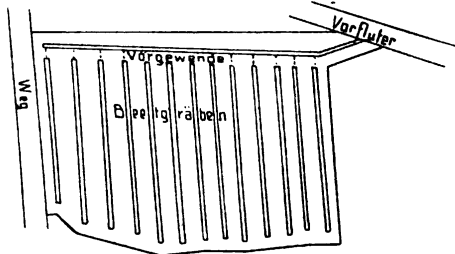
Lageplan einer Rimgauschen Moordammkultur.
